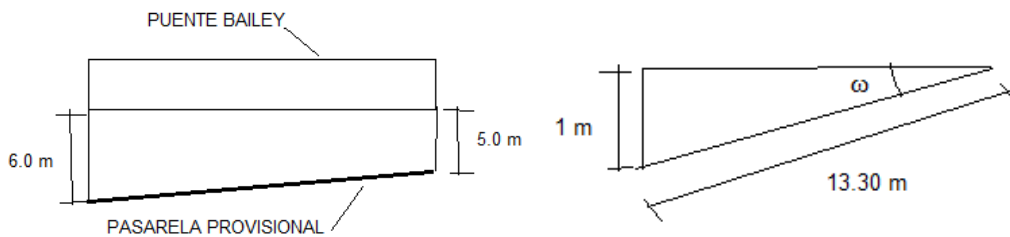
Ángulo de giro de puente Bailey, sin escala.
